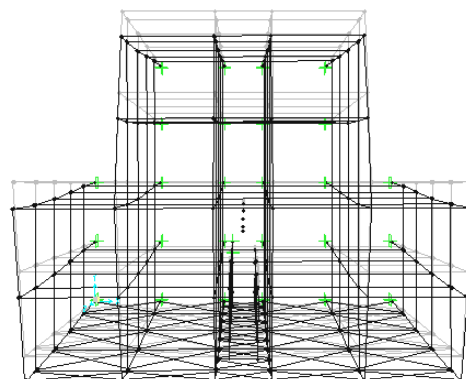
Edificio con distribuzione delle tamponature molto irregolare in pianta
